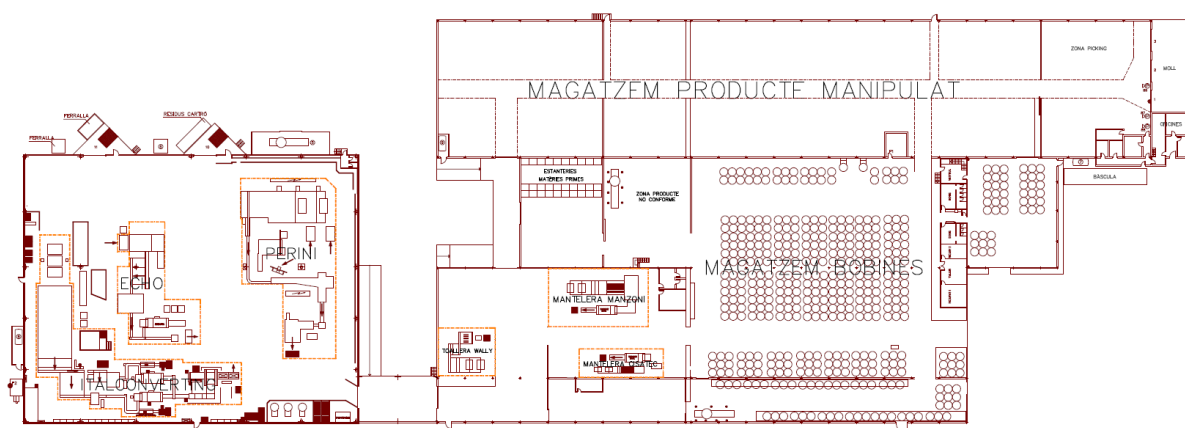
Plànol general de la planta (Font: Pròpia)
